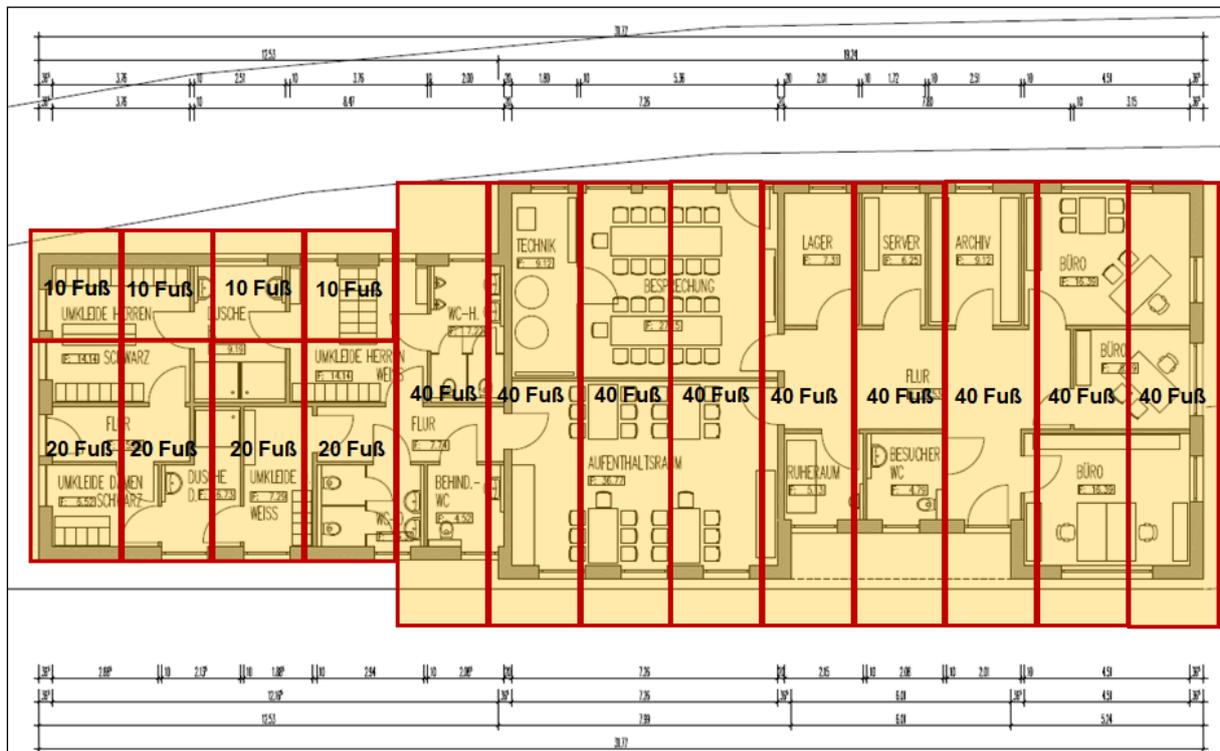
Schematischer Grundriss eines Gebäudes in Containerbauweise
